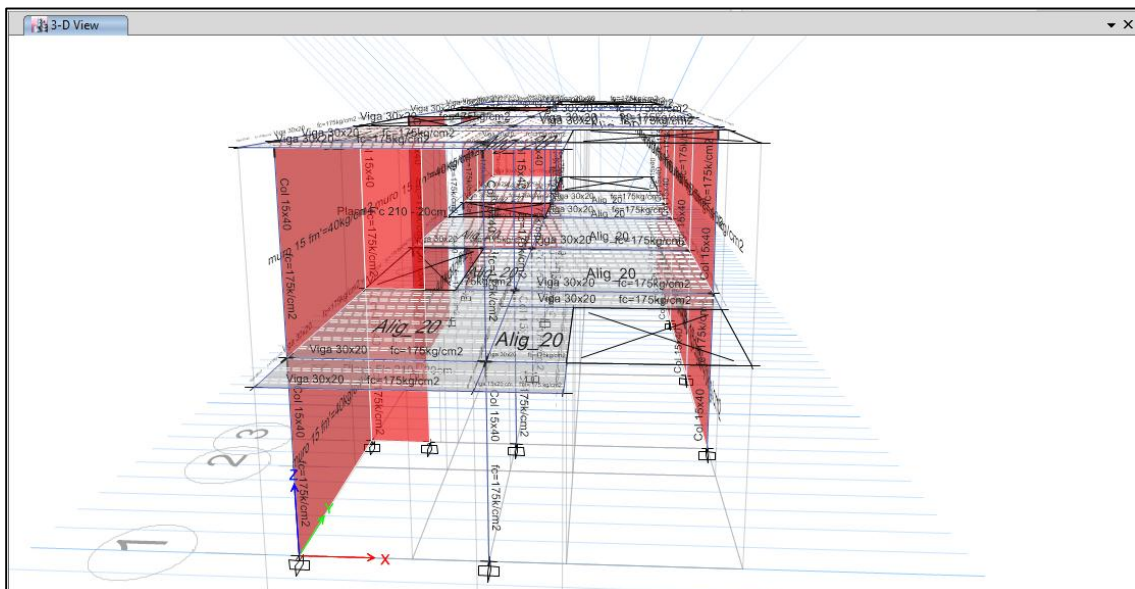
Vista tridimensional de la vivienda 1 reforzada con placa de concreto armado. Fuente:
